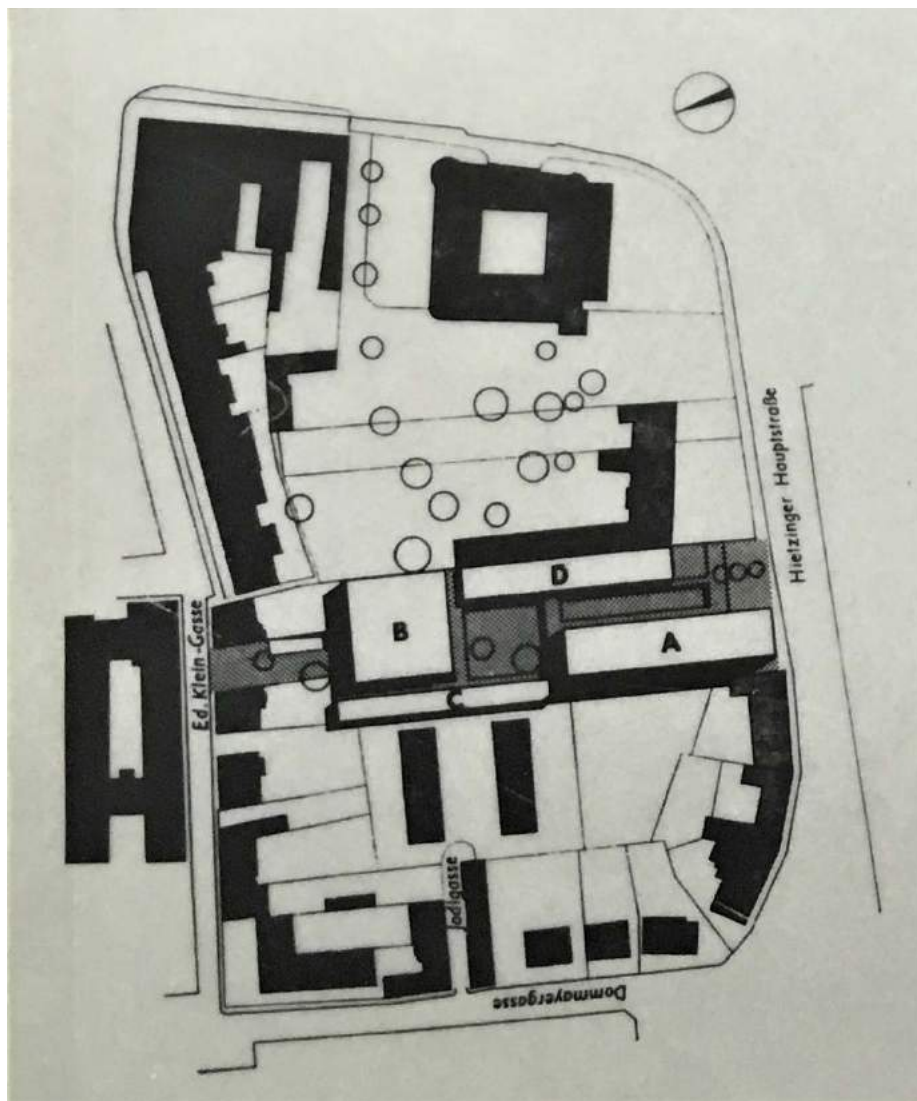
Lageplan Ekazent Hietzing, errichtet 1961-64
